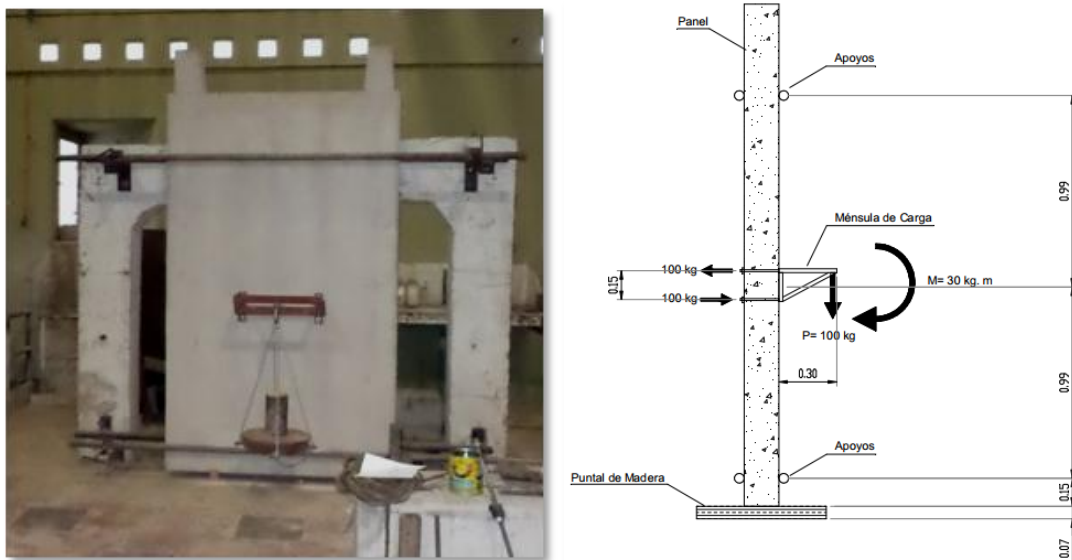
Detalle Dispositivo para Ensayo IRAM 11.585.
